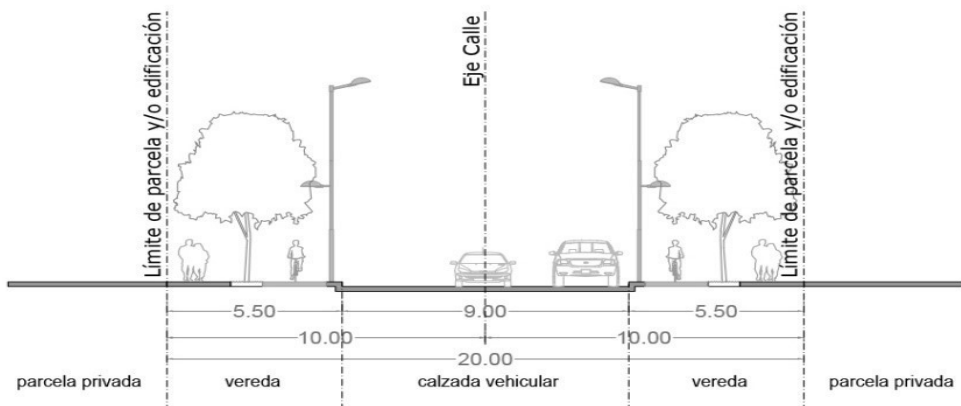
Sección transversal de Vías Calles Tipo 8.
